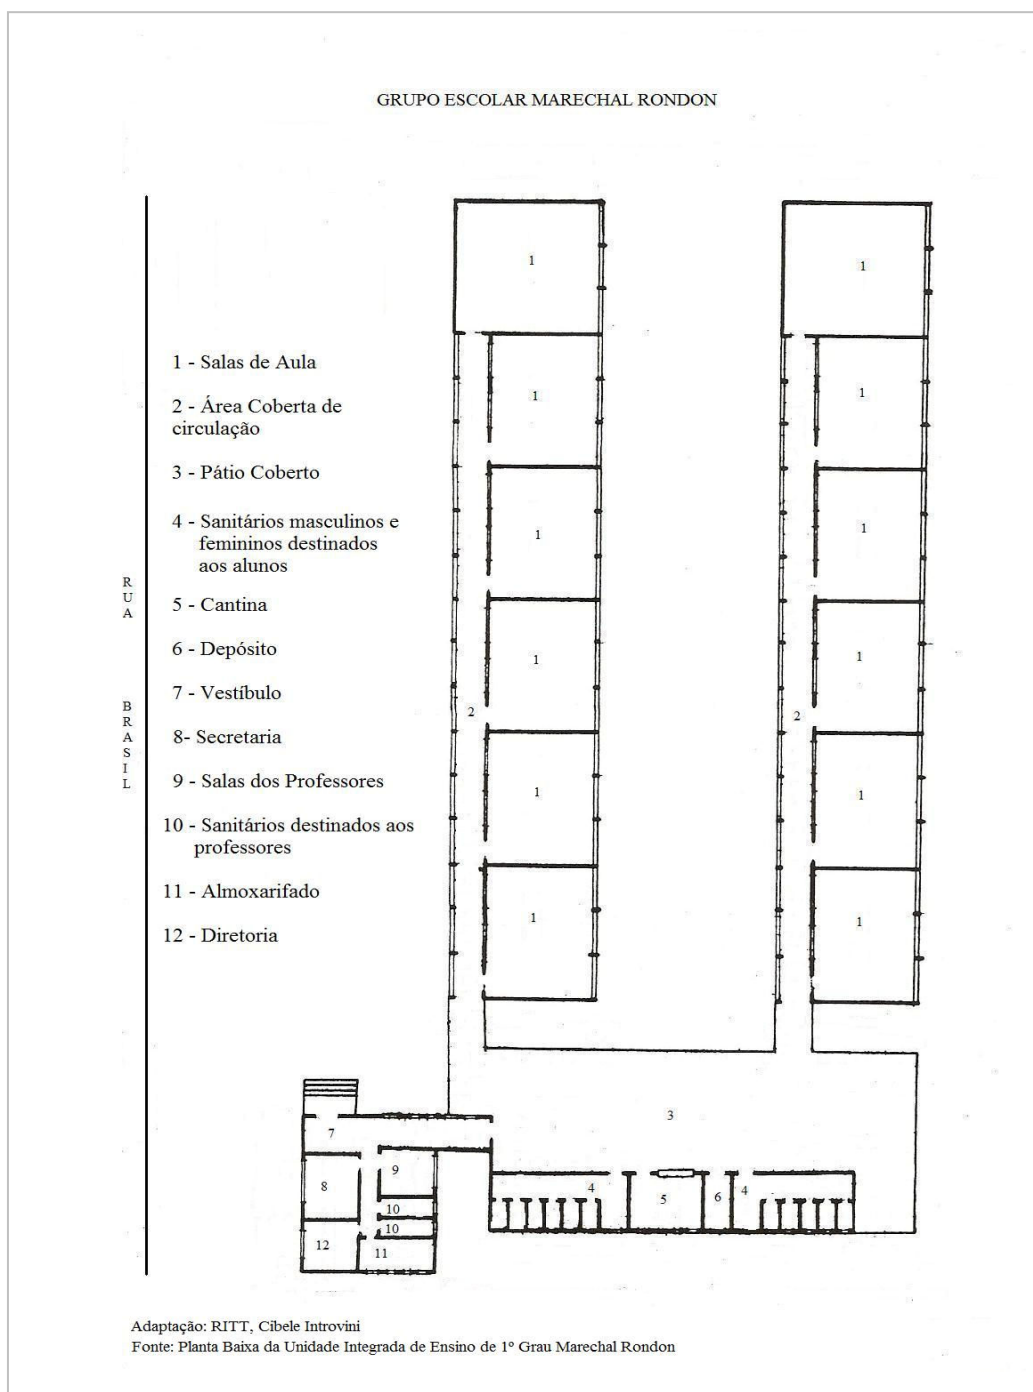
Planta Baixa do Grupo Escolar Marechal Rondon na década de 1960
